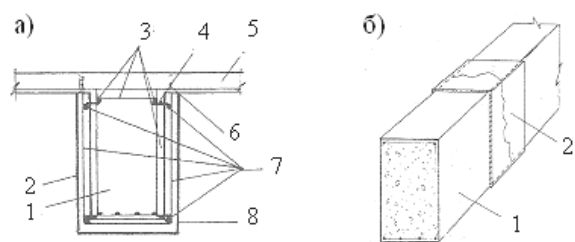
Усиление железобетонных балок и прогонов устройством железобетонной рубашки (а) и установкой стальных хомутов (б):
